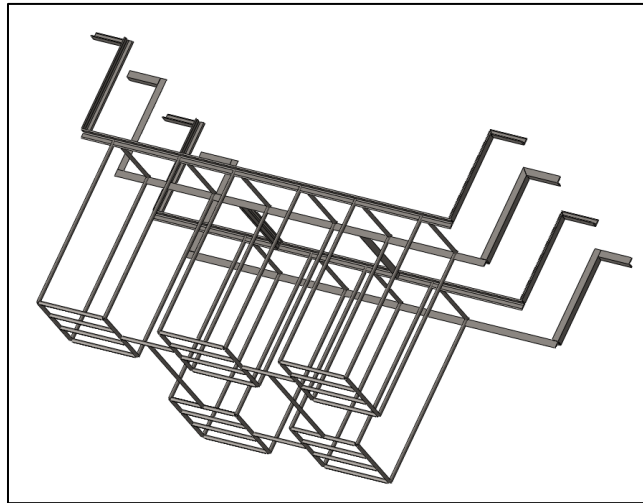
Diseño en SOLIDWORKS de tanque rectangular.
